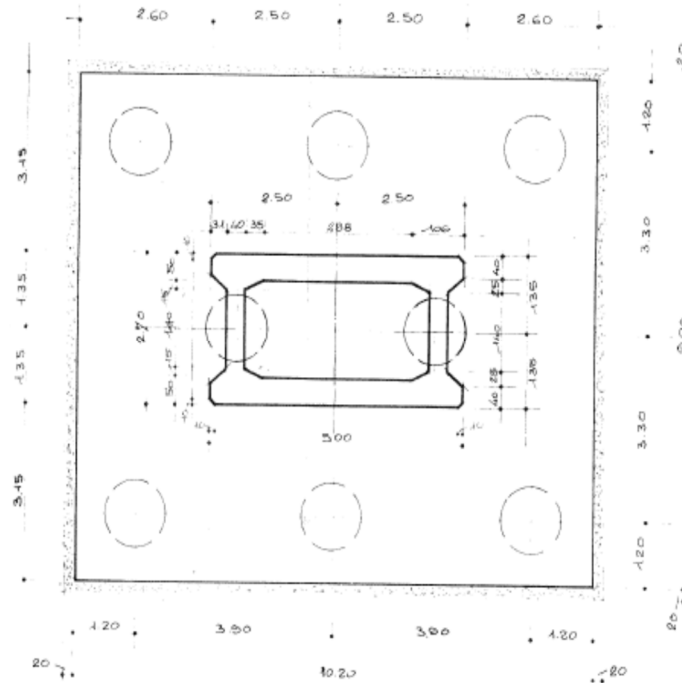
Pianta della fondazione su dei pali, 8 pali
